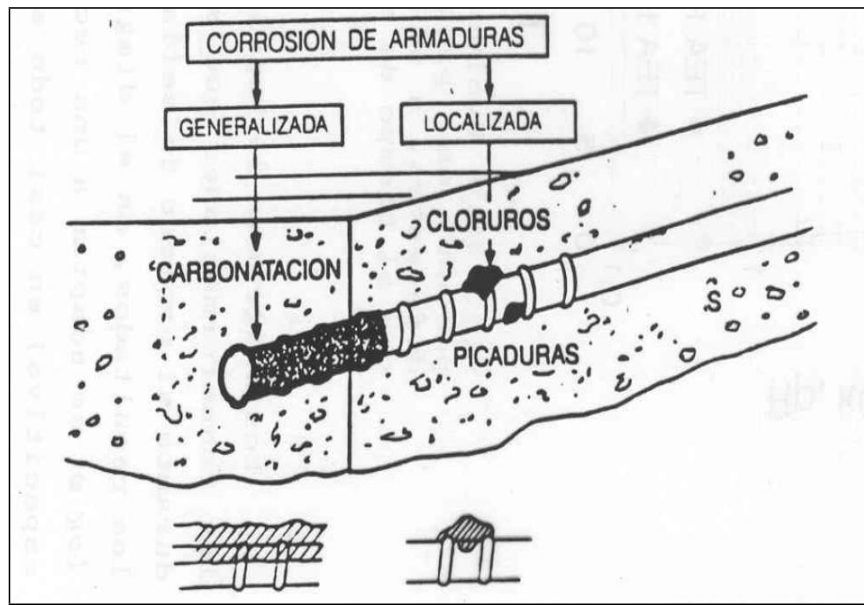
tipos de ataque por corrosión de armadura.
